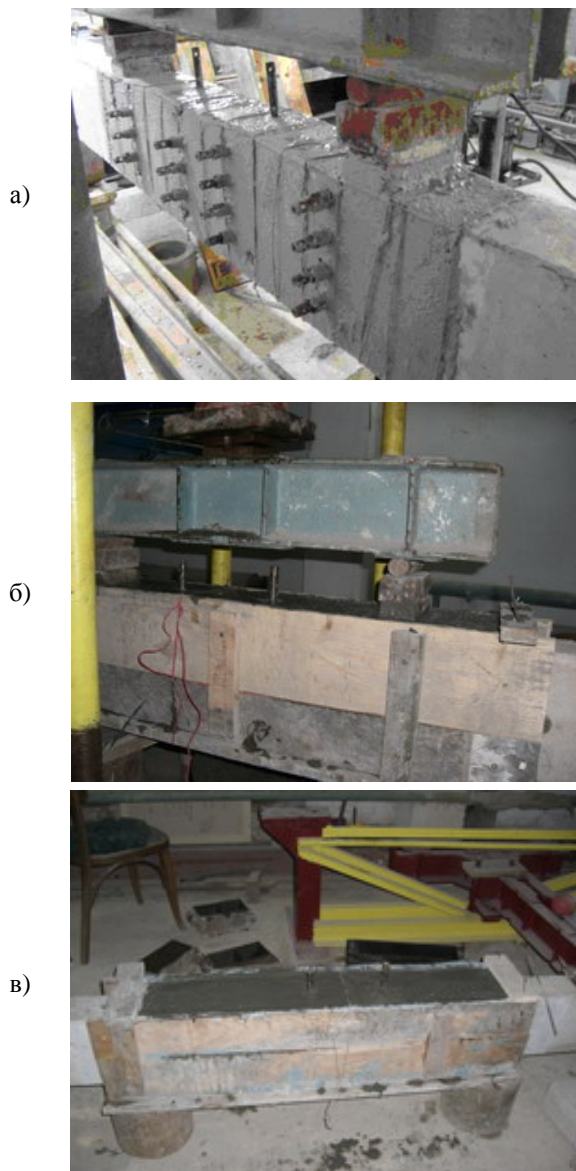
Підсилення балки бетонною обоймою: а) нанесення з'єднувального шару; б) влаштування бетонної обойми під навантаженням ; в) влаштування бетонної обойми без одночасної дії навантаження.
